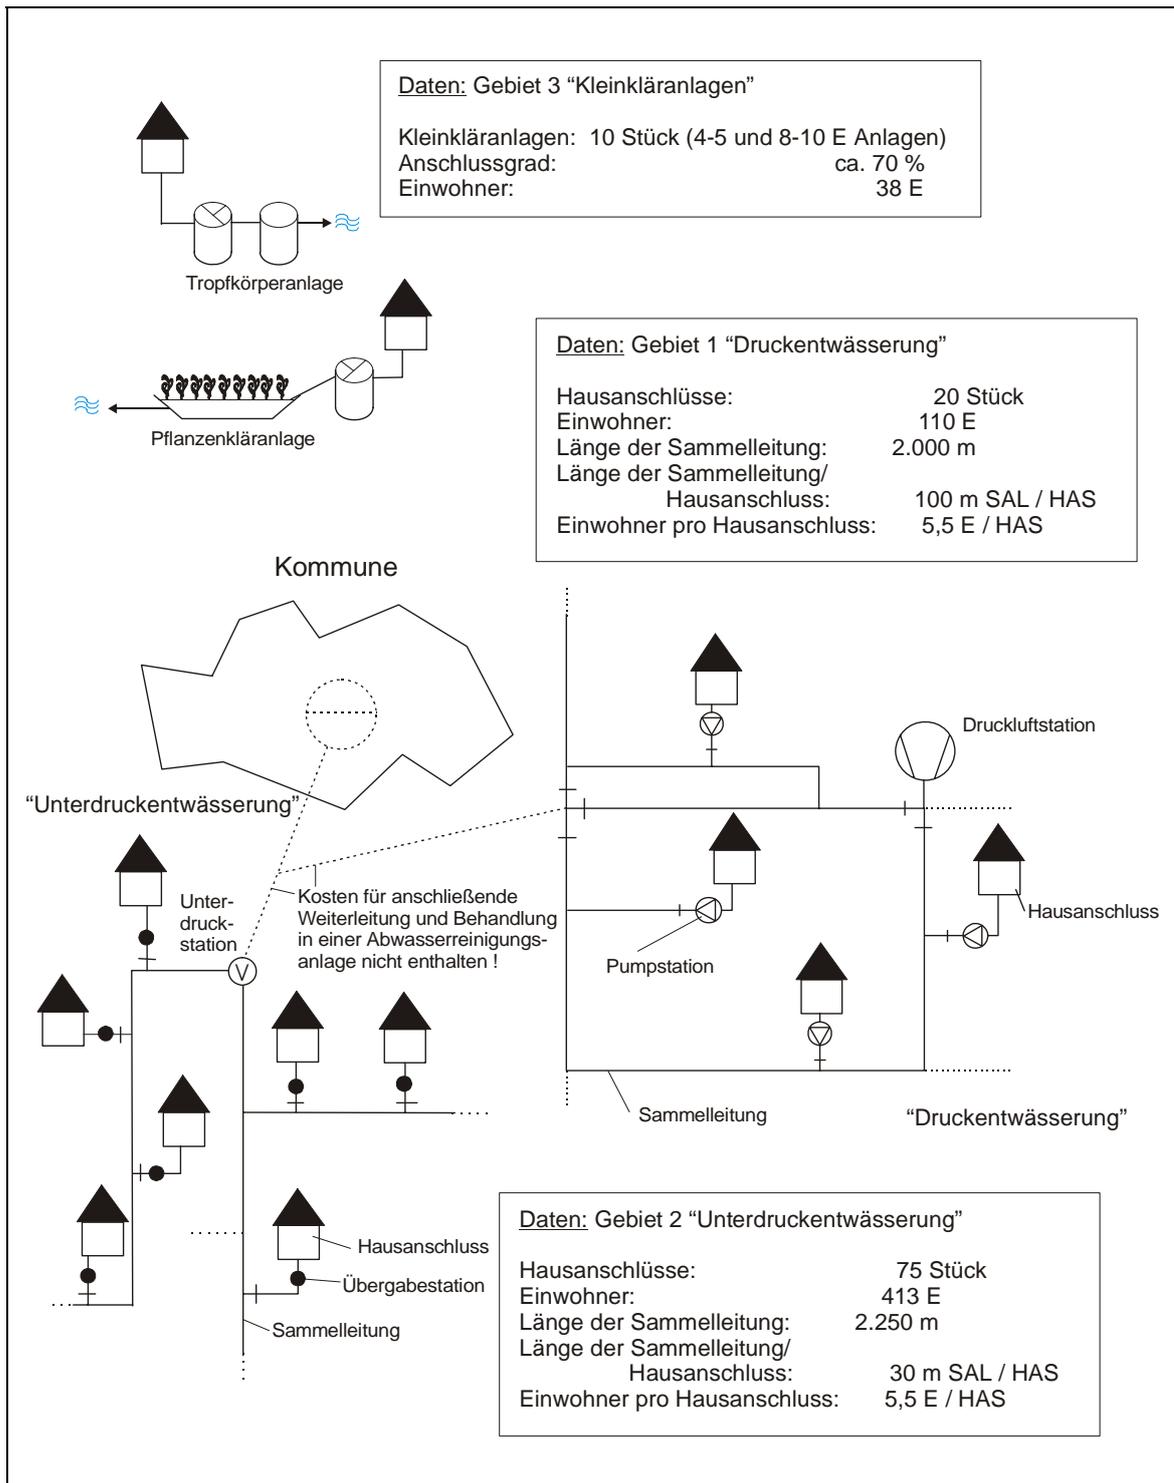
Betrachtete Anwendungsbeispiele - Übersichtslageplan
